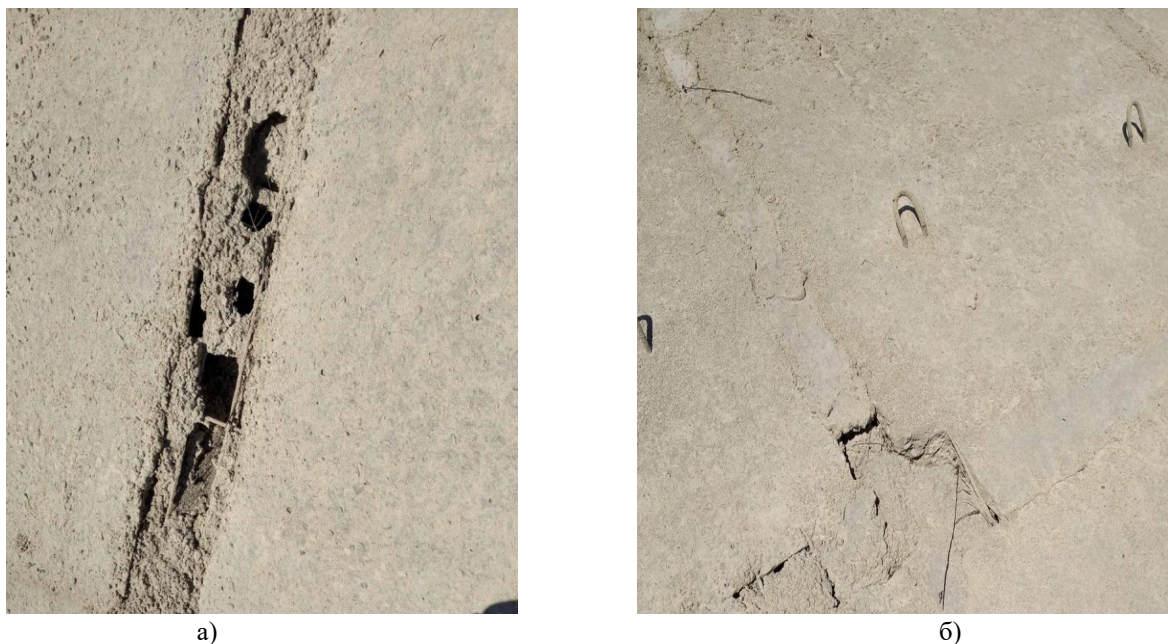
Состояние швов между железобетонными плитами на верховом откосе плотины
